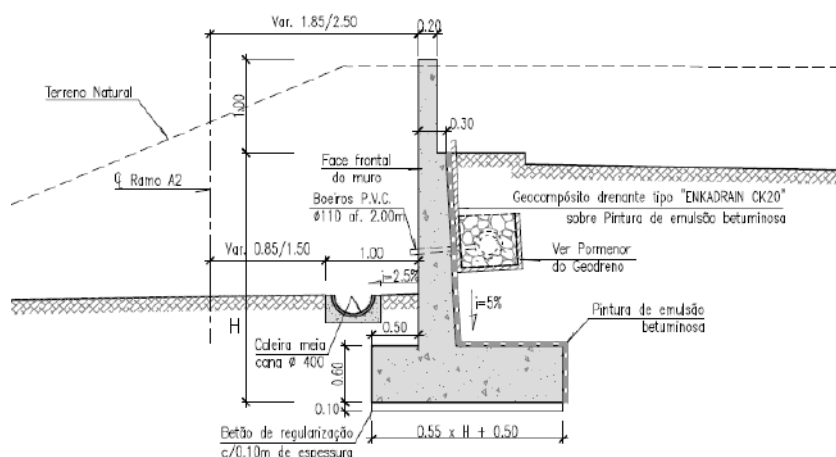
Muro M4 – Secção transversal tipo em “L”.
